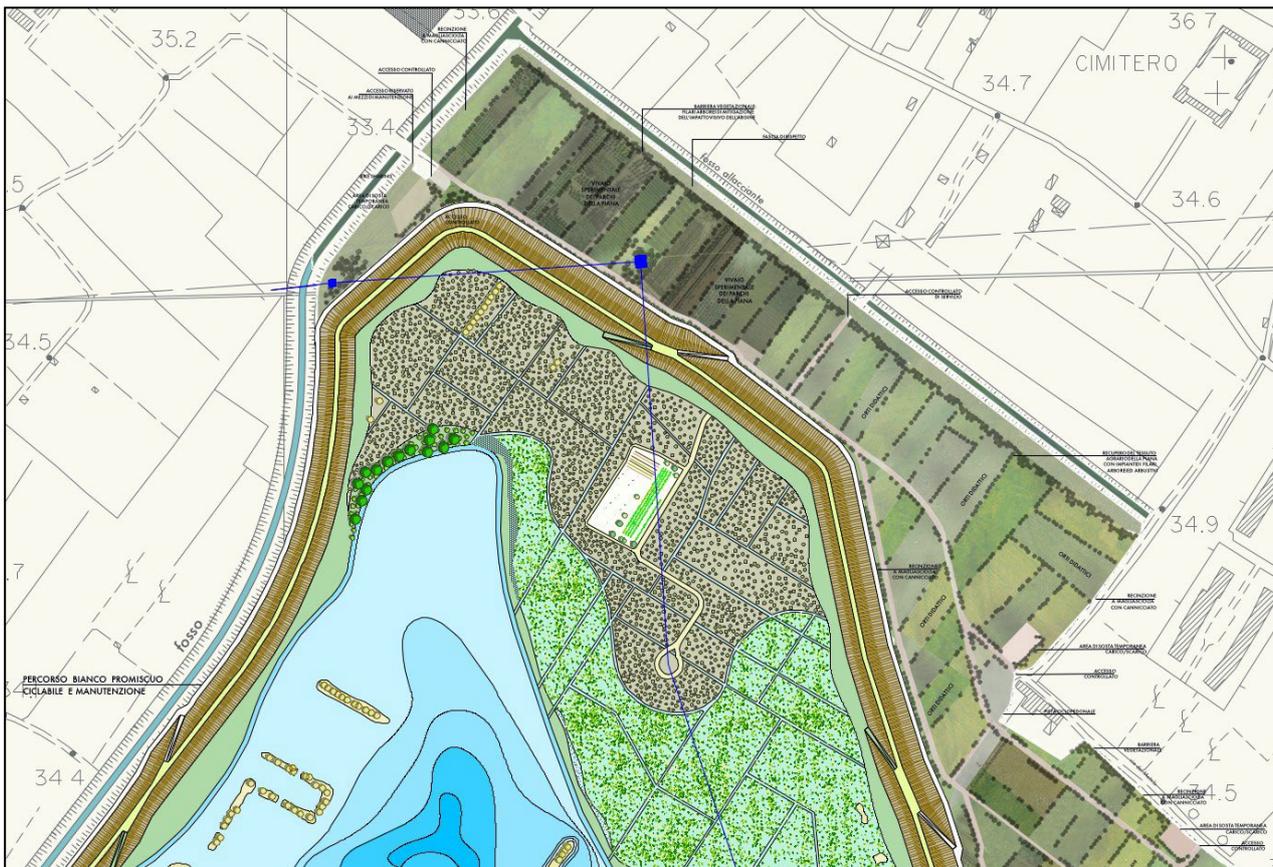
Planimetria del progetto del parco Didattico e Vivaio Sperimentale
